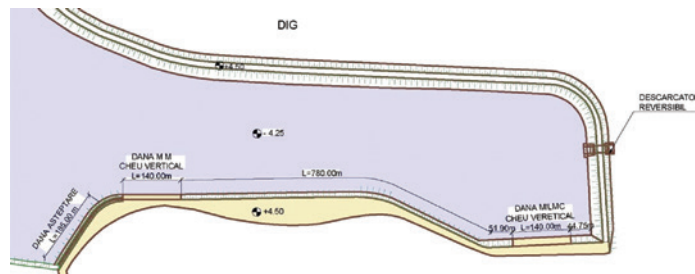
Plan amplasament port Luminița în zona de nord a Lacului Tașaul
